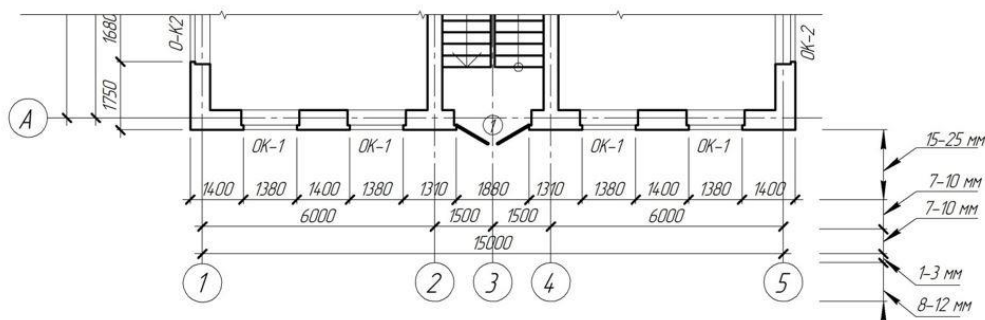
Требование к нанесению наружных размеров на плане этажа
